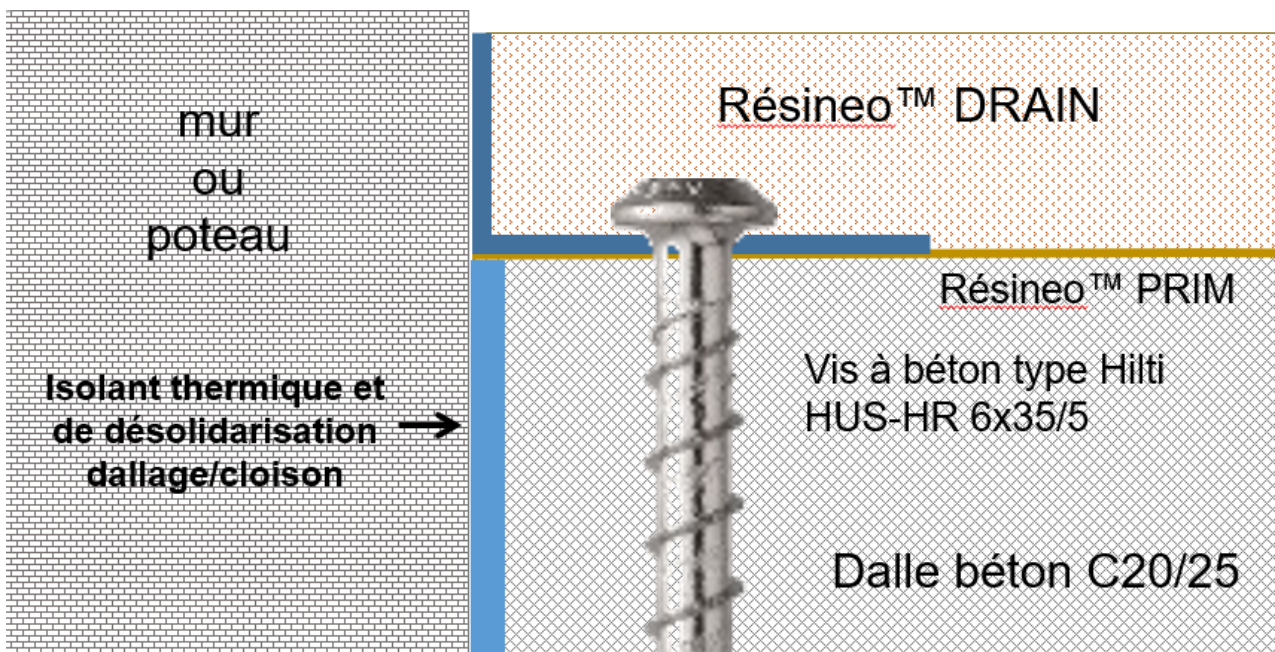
Arrêt sur mur par profil en L (rénovation)
